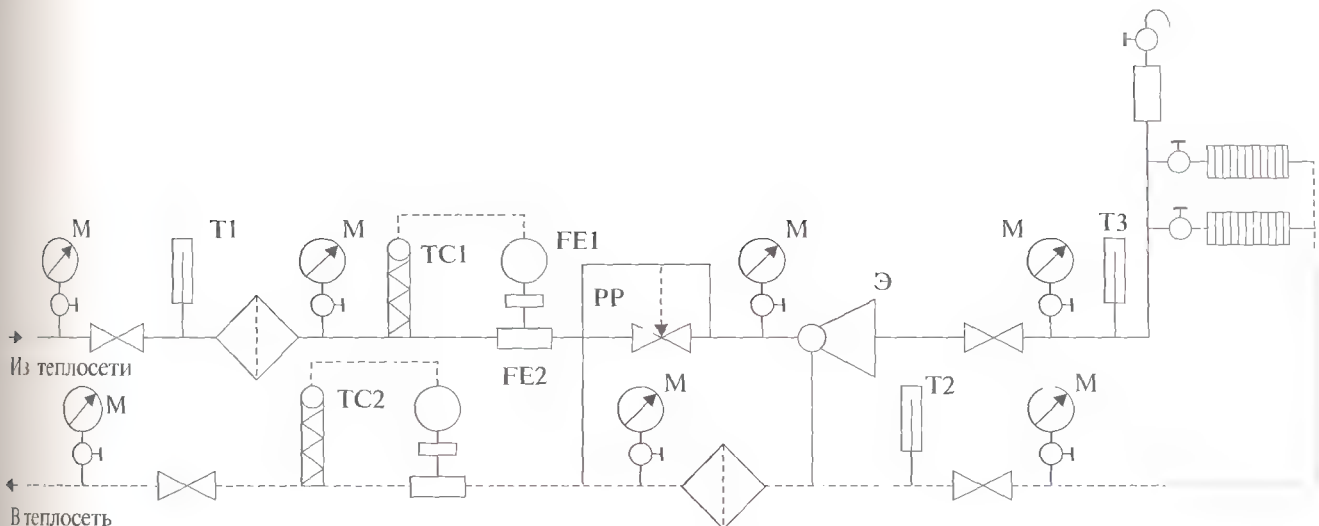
Схема теплового узла элеваторного присоединения системы отопления к тепловым сетям
